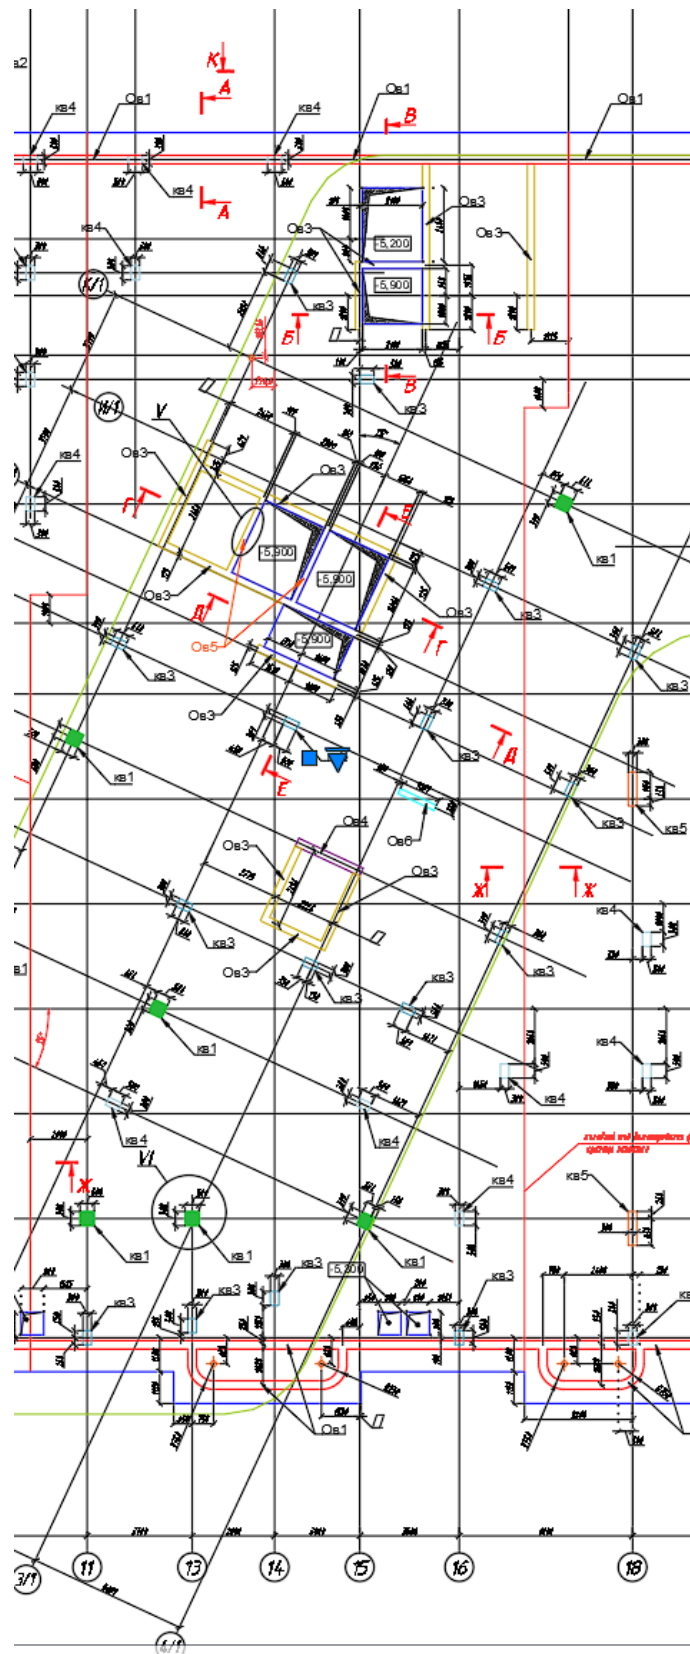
Схема расположения фундамента в осях 11-18, А-Ф
